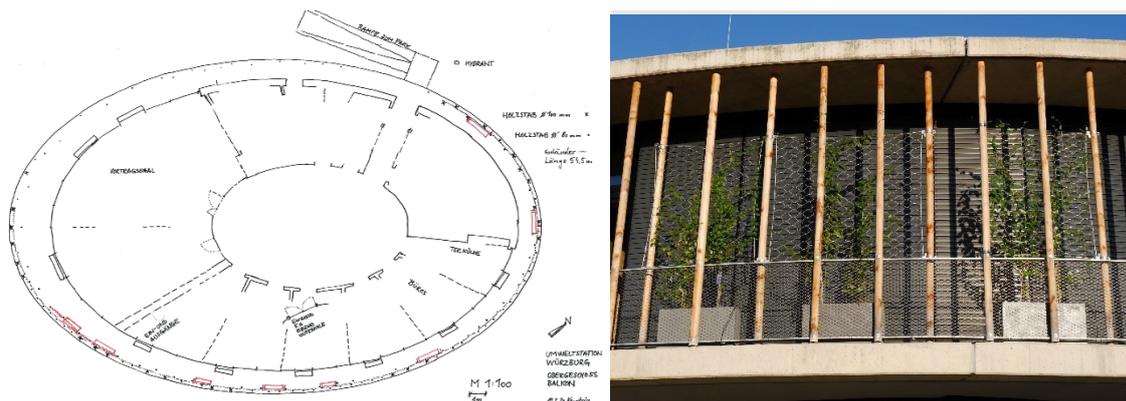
Ausführungsplanung der Fassadenbegrünung (© Bay. Landesanstalt für Wein- und Gartenbau; links) und Ausschnitt nach Fertigstellung (Foto: J. Sängler, Umweltstation, rechts).
